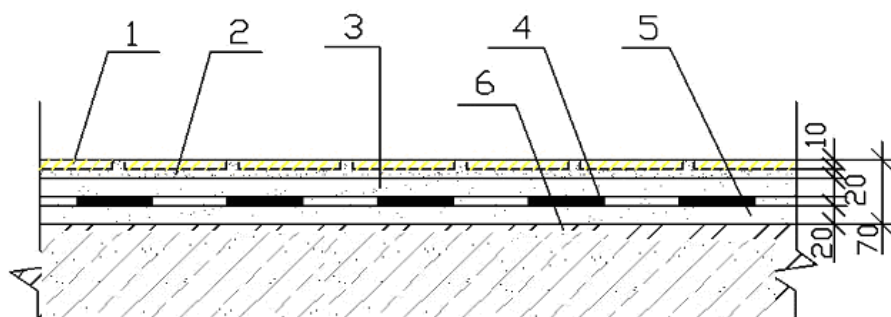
Підлога санвузлів (над перекриттям)
